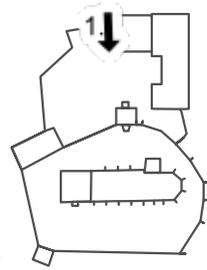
Grundriss der Kirchenburg in Jakobsdorf /Ag.
